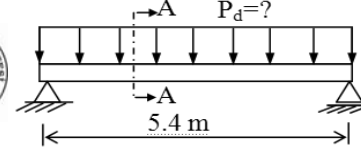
'de verilen kirişin boyutlarını kontrol ederek tasarımı yapınız.
